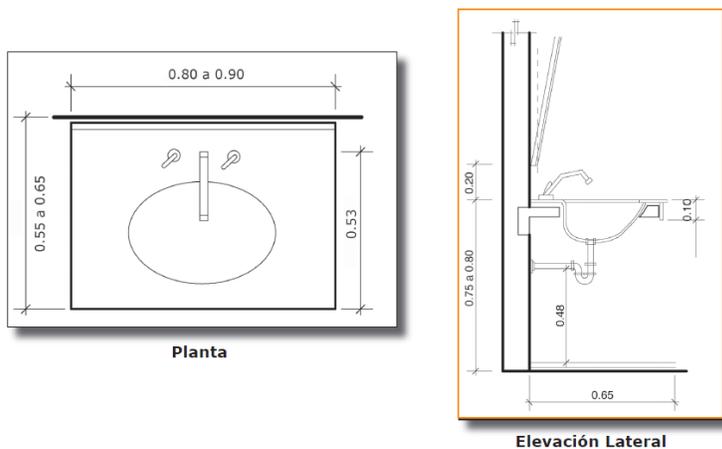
Planta y elevación lavamanos, CONADI, 109.
